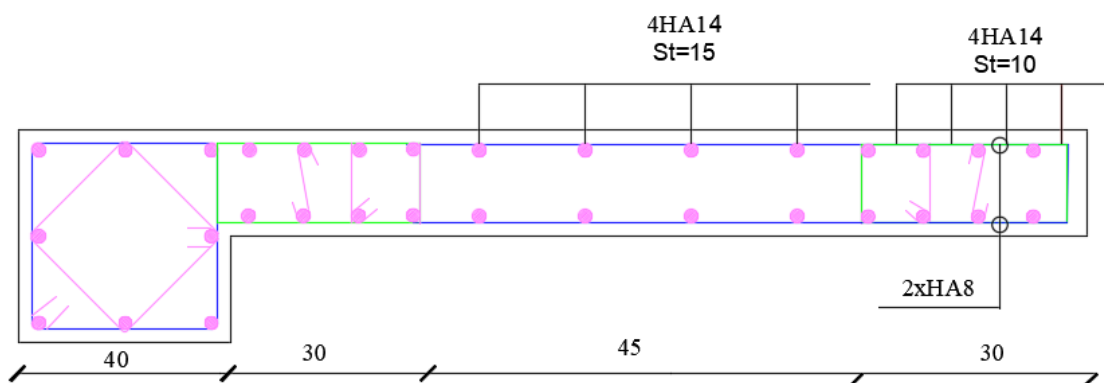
Schéma de ferrailage voile 105×20 (cm²).
